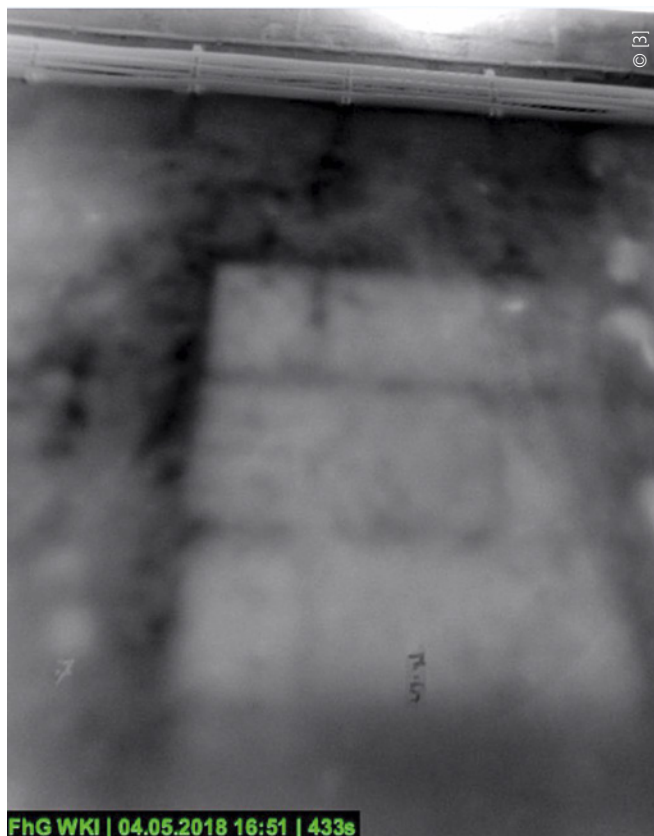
Nachträglich zugemauerte Öffnung in einer Wand
